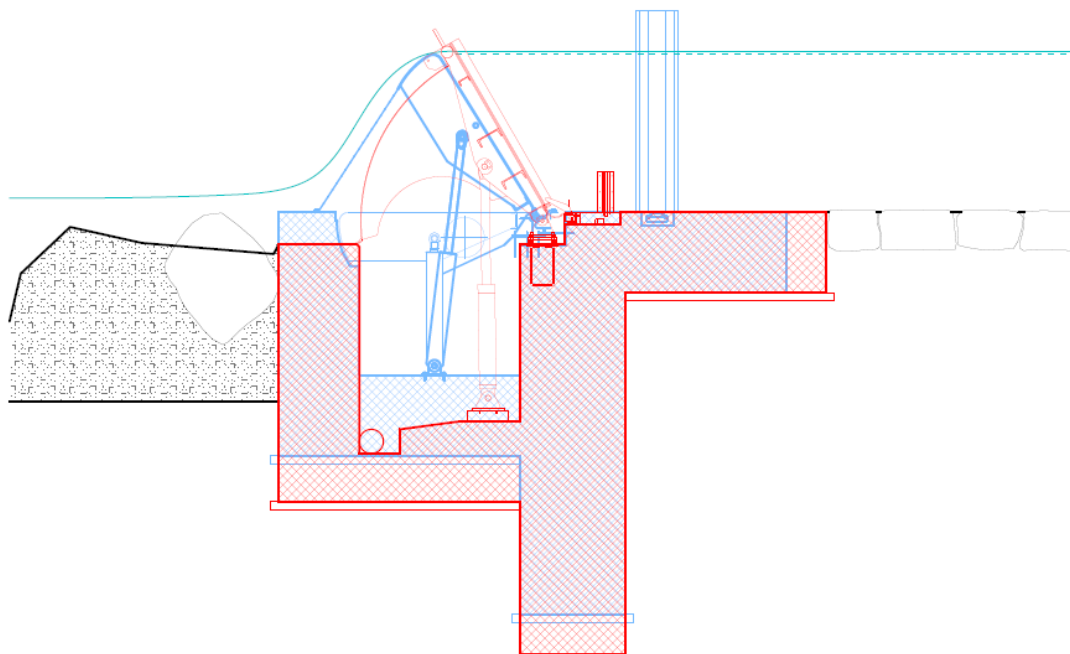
Raffronto traversa di derivazione (rosso variante – azzurro autorizzato)
